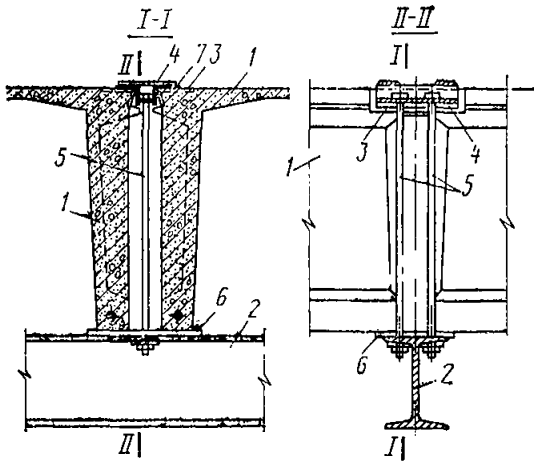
Узел крепления балок крановых путей подвесного транспорта к покрытию из панелей-оболочек КЖС (в середине пролета)
